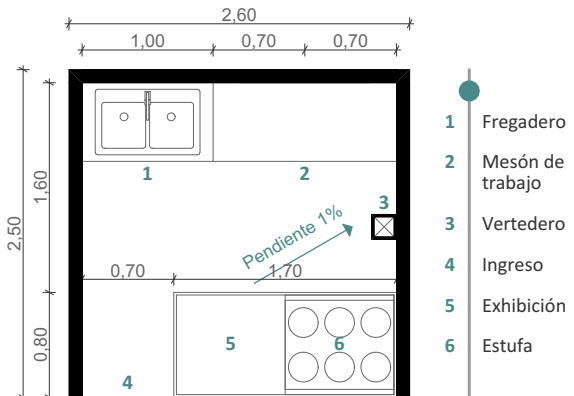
Planta de tortillería. Fuente: Autores.
